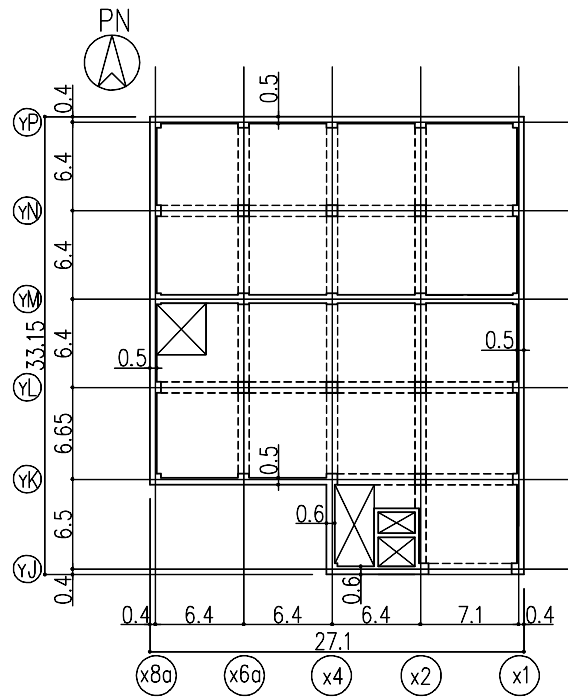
地下1階平面図 (G.L. -4.2) (单位 : m)
